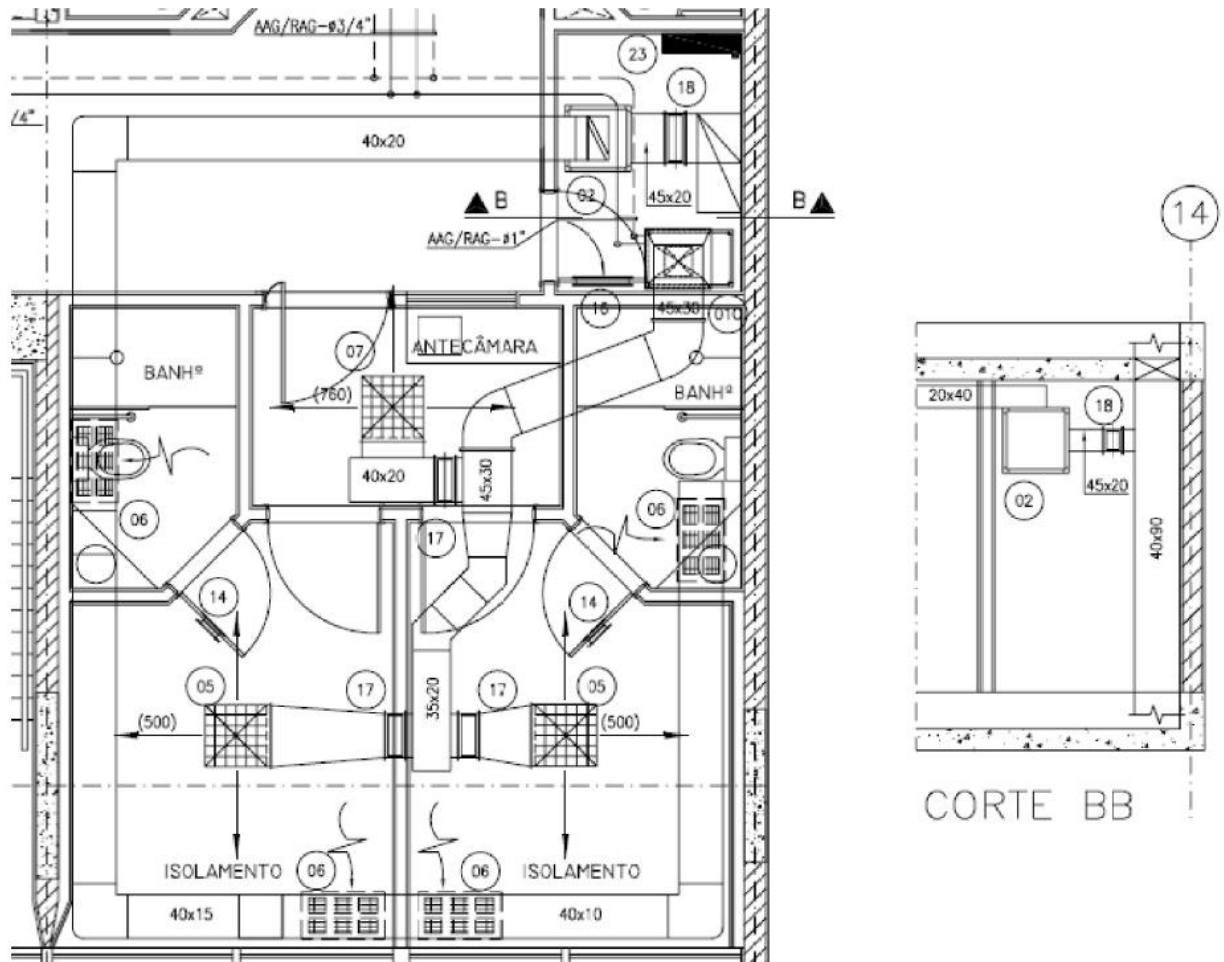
Sala de isolamento de um hospital – planta baixa e corte - s/ escala
